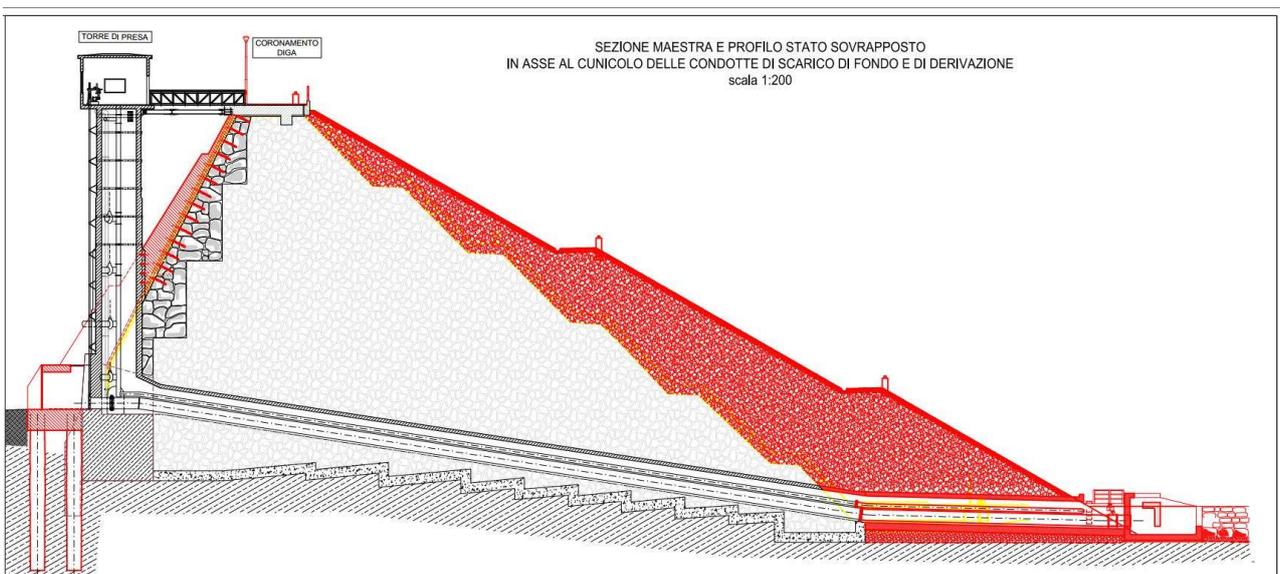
Sezione maestra dell'opera di sbarramento. Stato sovrapposto. In rosso gli interventi in progetto
